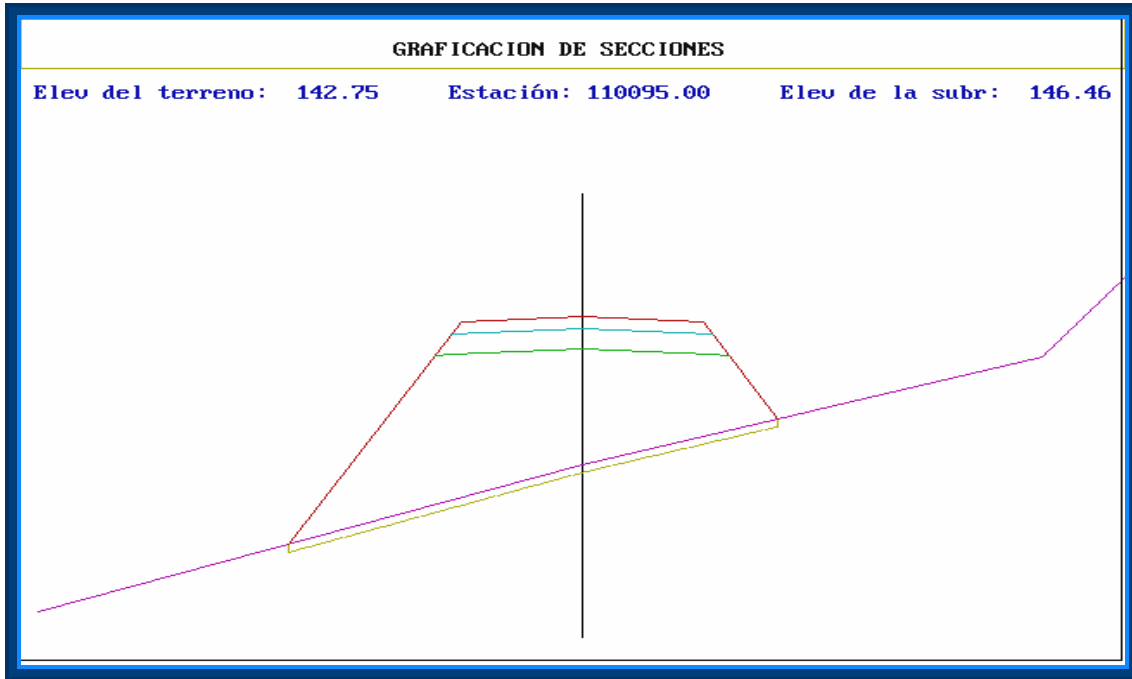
SECCIÓN EN TERRAPLÉN.
